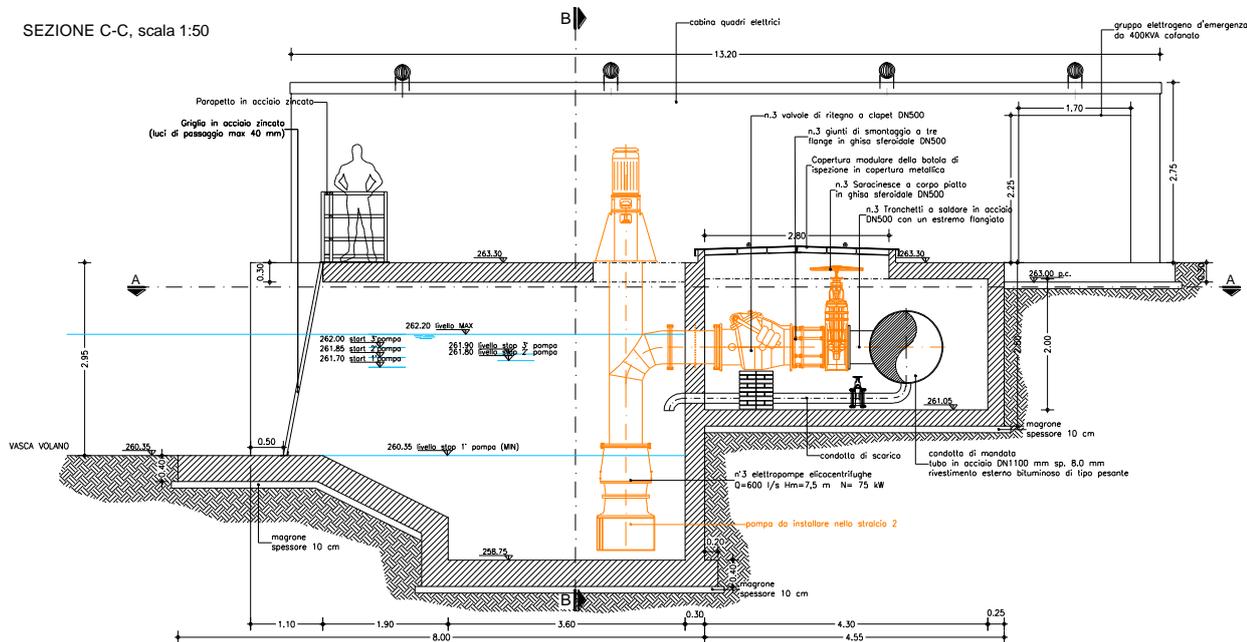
sezione dell'impianto idrovoro (estratto elaborato T-07). In arancione le opere previste nel 2° stralcio funzionale
